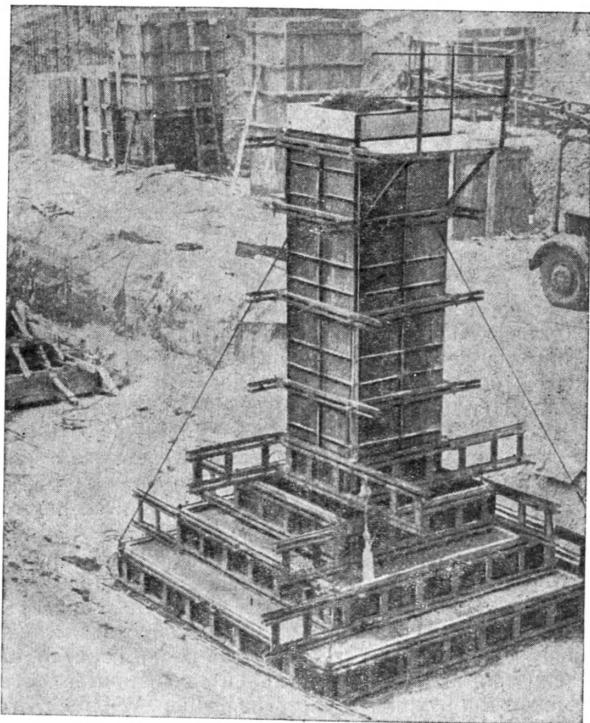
Общий вид стальной опалубки тяжелого ступенчатого фундамента (опалубка ЦНИИОМТП)
